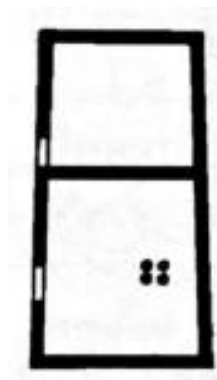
Grundstück R. Defant (1988): Schematischer Grundriss.
